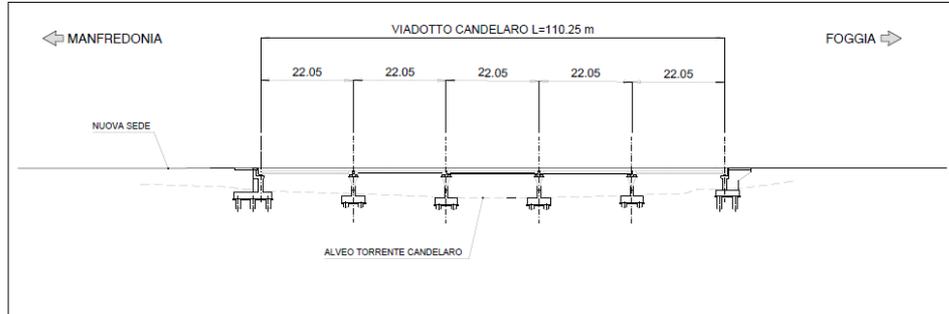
Viadotto Candelaro PD 2007 – Planimetria
